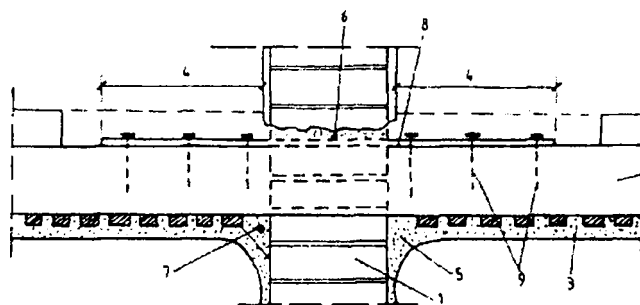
Ancorarea grinzilor de lemn de peretii portanți interiori. cu poziția tirantului în lungul peretelui:
